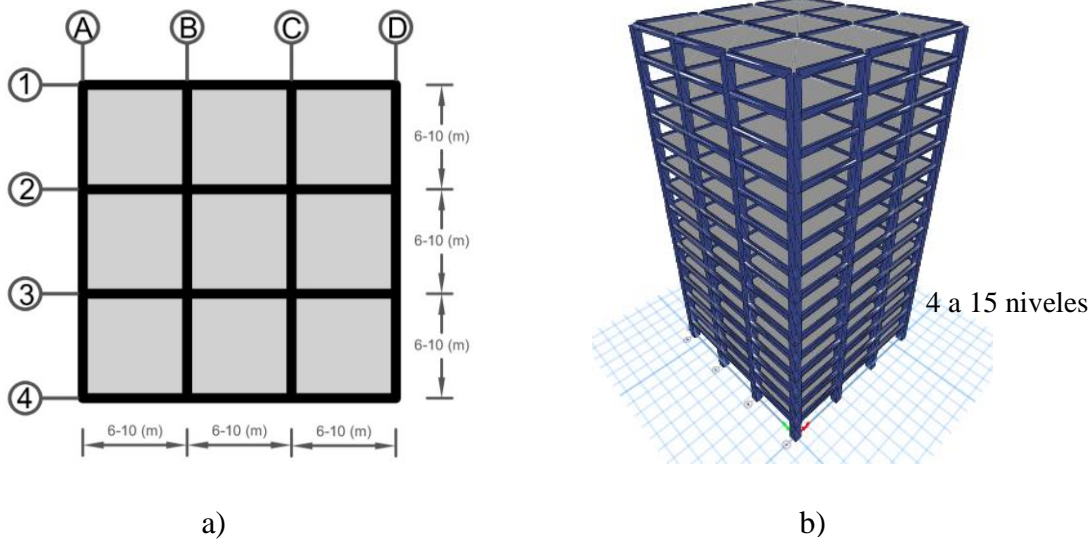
a) Esquema de planta tipo b) Diagrama de elevación tipo.
